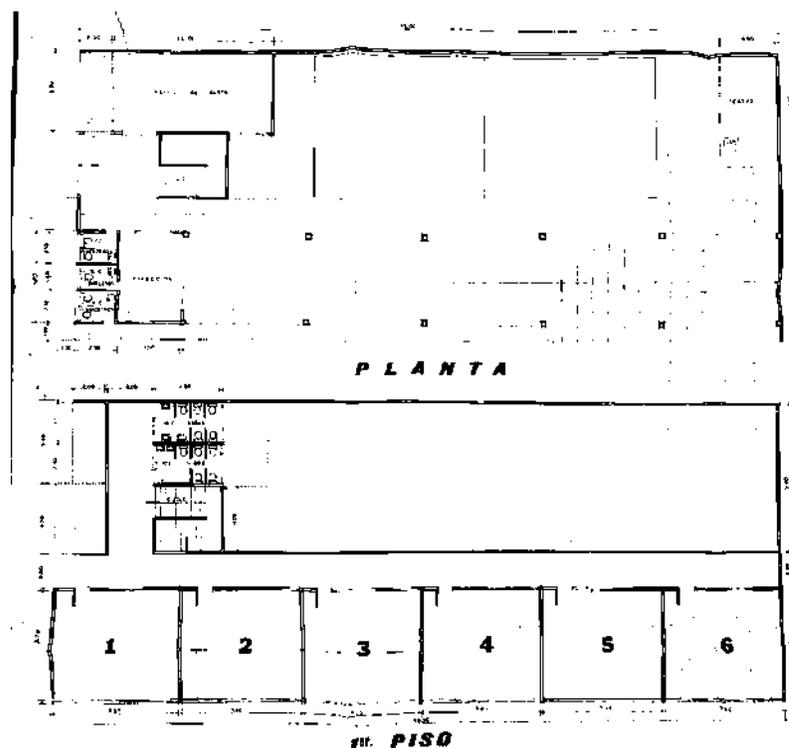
Planimetría 1 escuela Apolonio M. Avilés.
